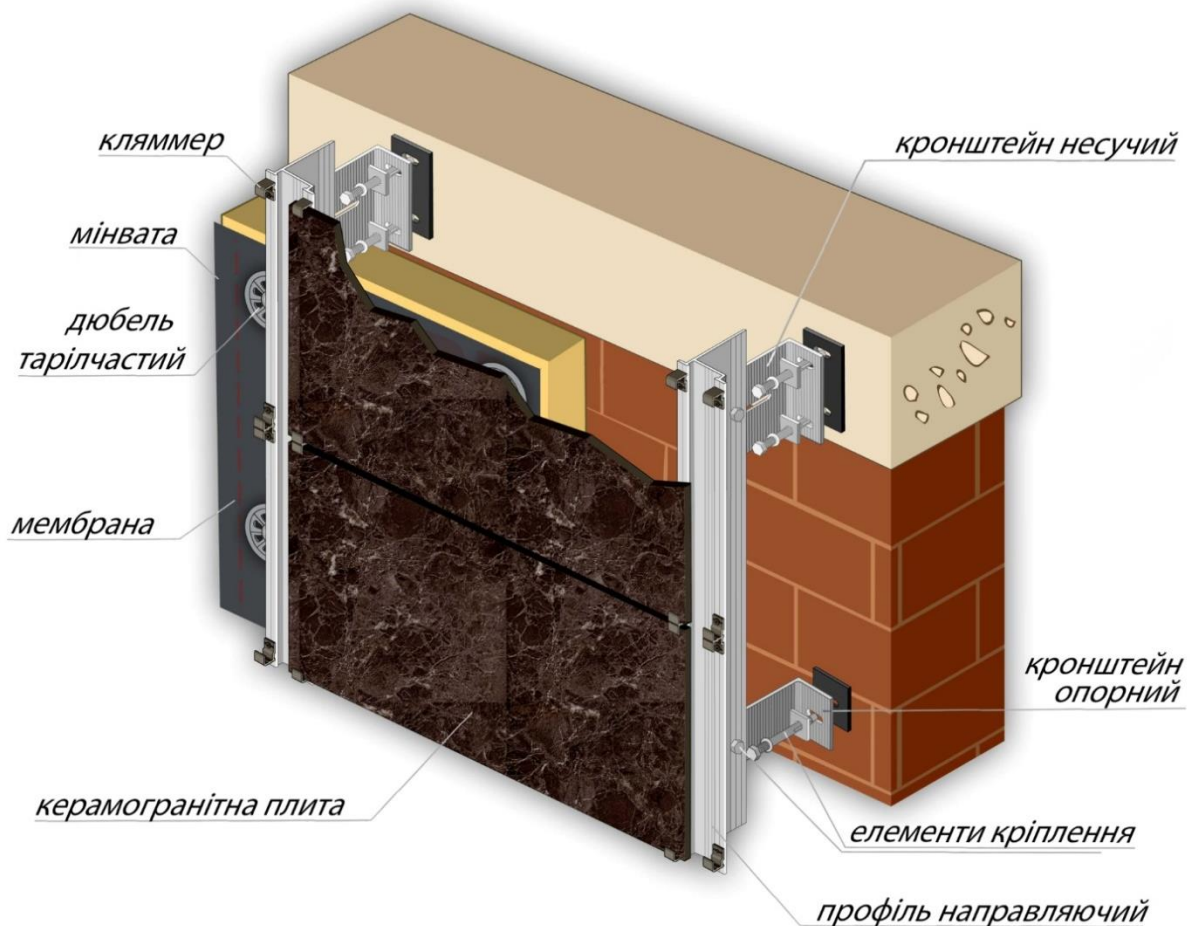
Схема навісного вентиляованого фасаду. Розташування несучих кронштейнів
